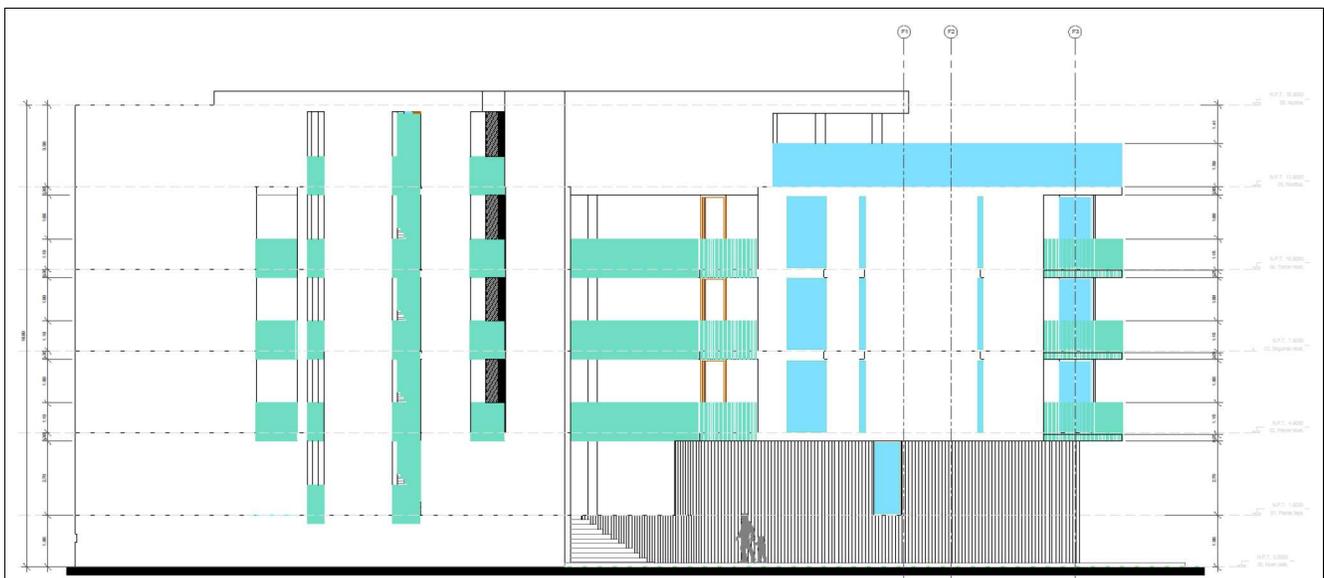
Se muestra la fachada del edificio sobre la Calle Albatros.
